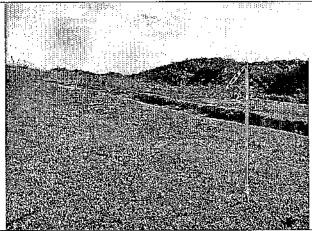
Jazida Paulo Lopes - Const. Ivai – lote 23
